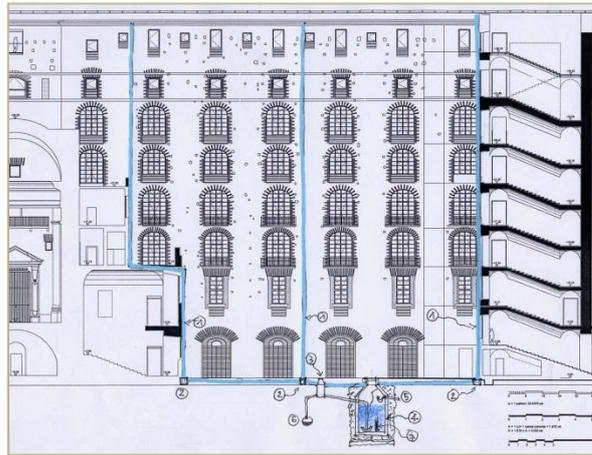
sezione- prospetto, schizzo di studio arch. F. Brancaccio e immagine di una delle canalizzazioni ritrovate nei restauri
